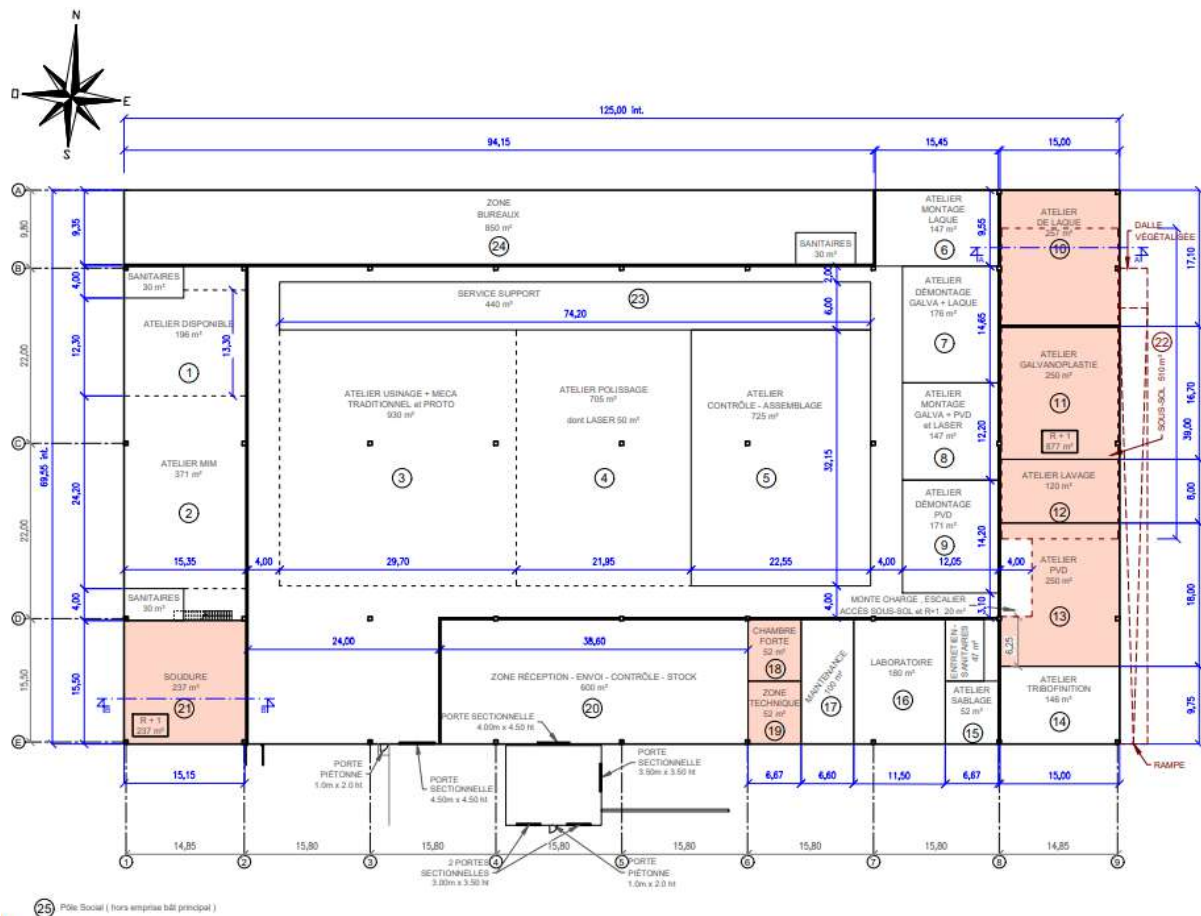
PLAN DE LOCALISATION R+1 EN MEZZANINE
